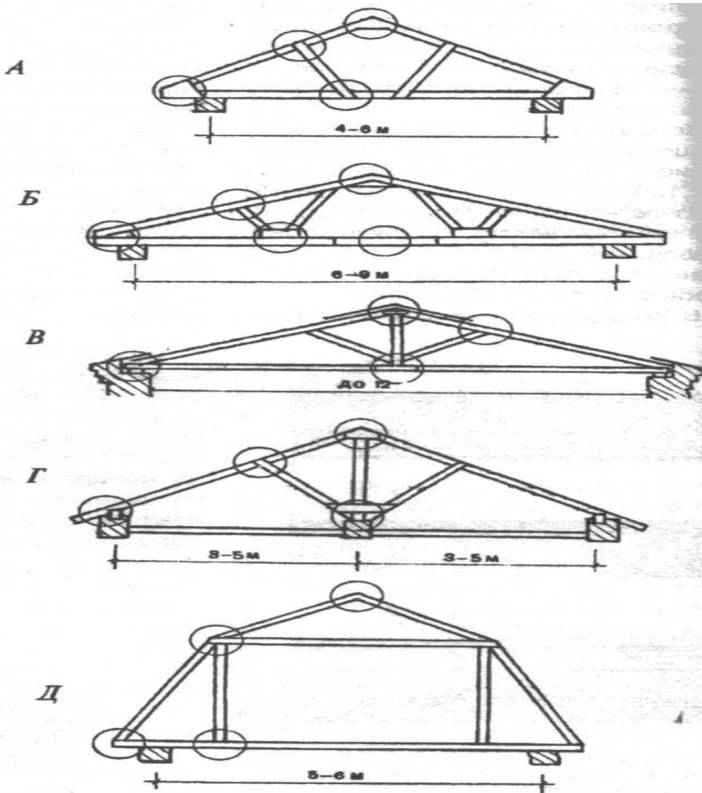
Кроквяні ферми: А - висяча ферма однопрогінного будинку; Б - ферма з підкосами; В - ферма для однопрогінного будинку більше 8 м; Г - похила кроквяна ферма; Д - ферма для мансардного даху.
